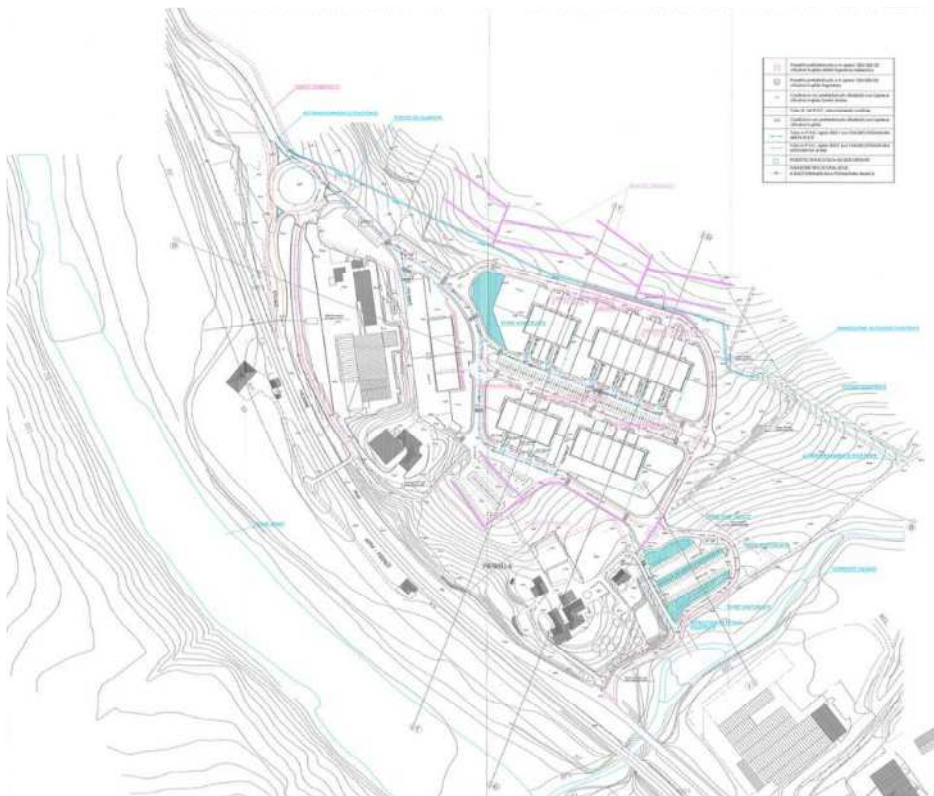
Estratto Tav. n. 6 – planimetria generale riassuntiva del PUC vigente
